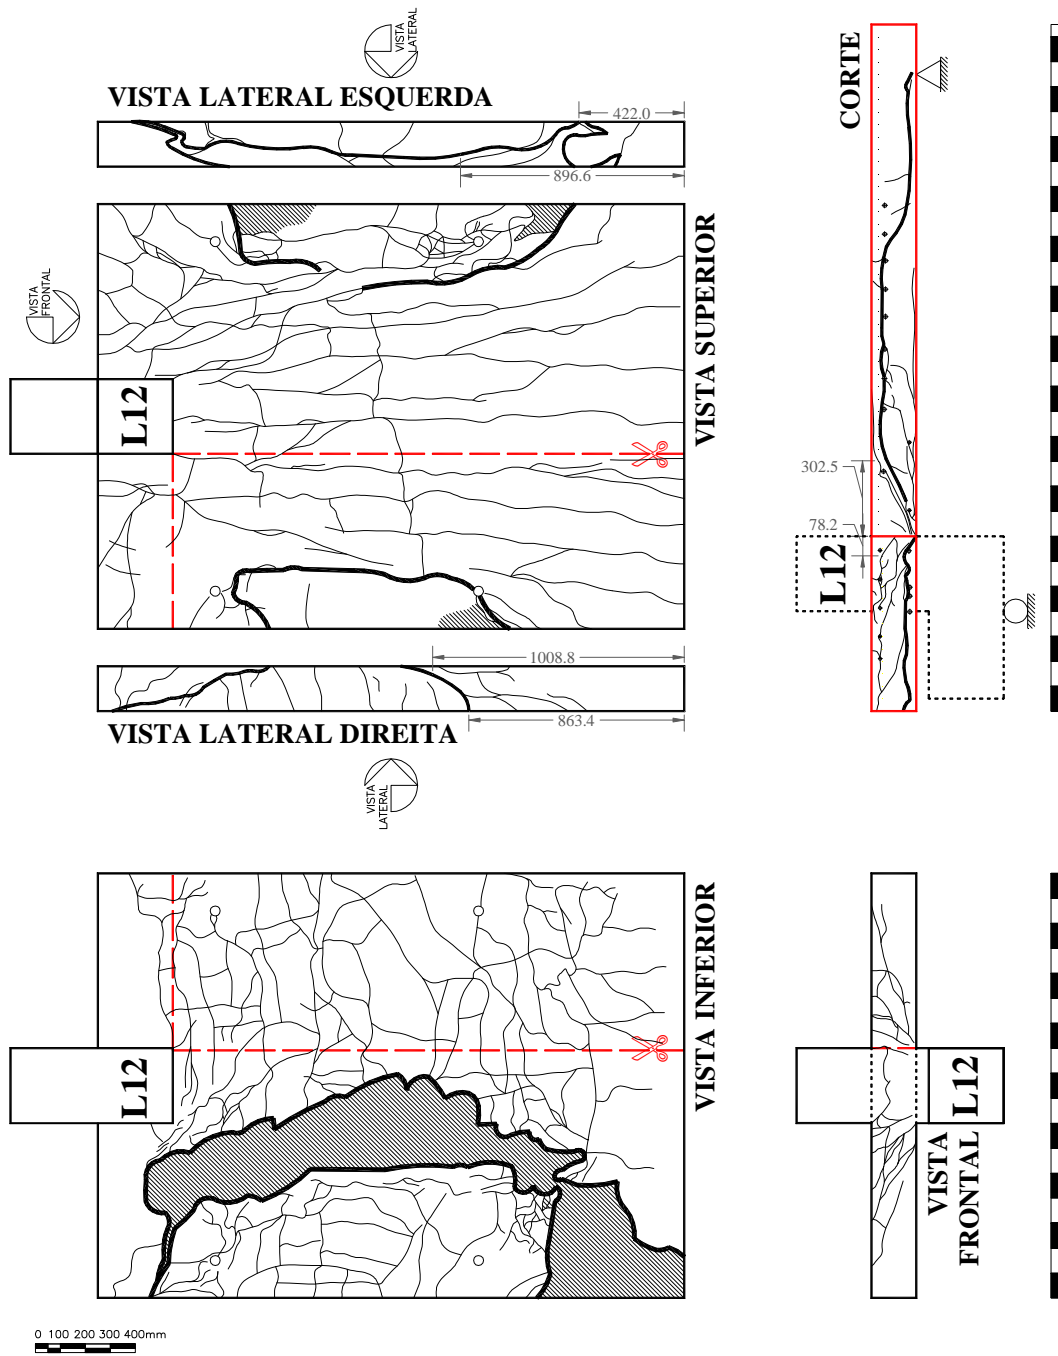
Padrão de fissuração da laje L12
